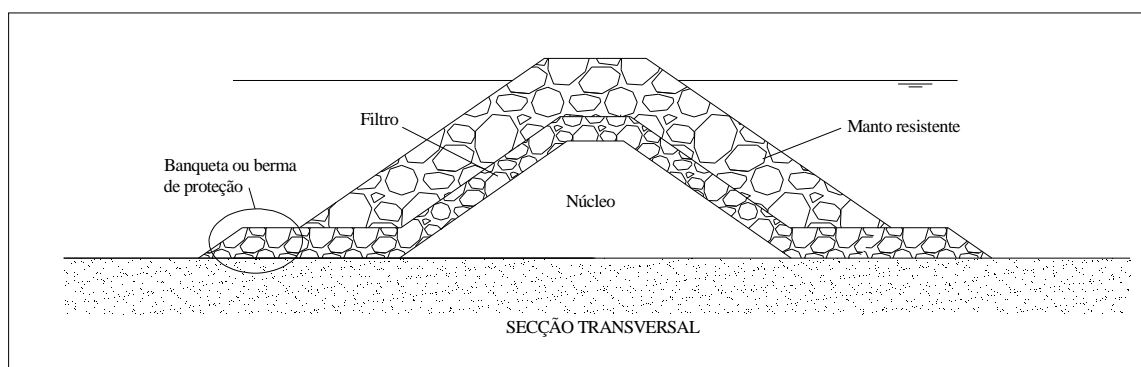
Secção transversal de um esporão com berma de protecção.
